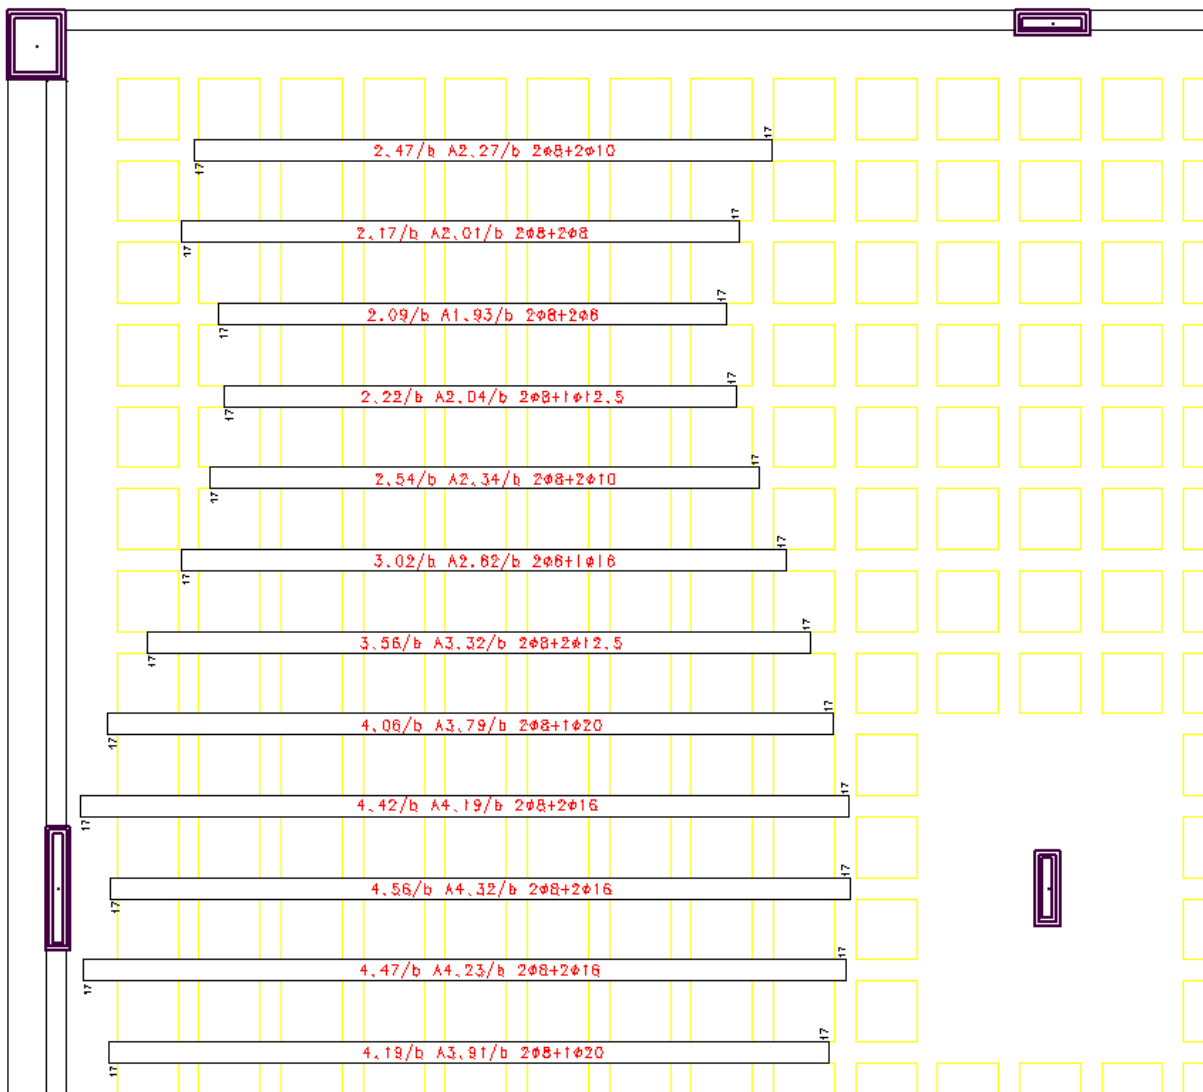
8 – Detalhe das faixas de armadura complementar à armadura de base – L205 – Armadura positiva horizontal.
